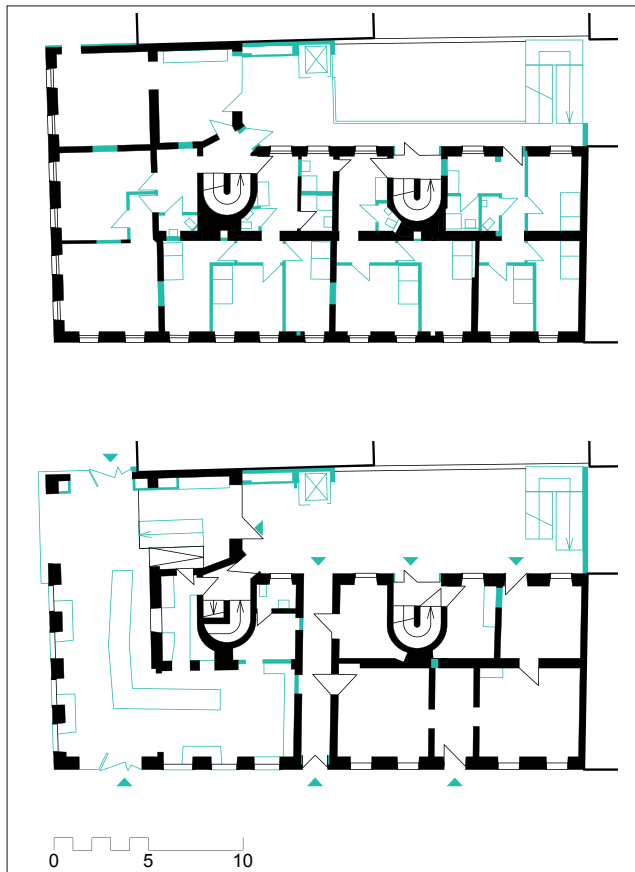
Grundrisse des Erdgeschosses (unten) und des Regelgeschosses (oben) des Projekts VinziRast-mittendrin mit Hervorhebung der Umbaumaßnahmen (grün) © gaupenraub+/-, Bearbeitung subsolar
